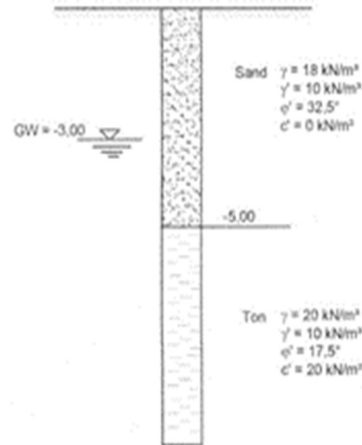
Baugrundaufbau für alle Beispiele zum Erddruck
